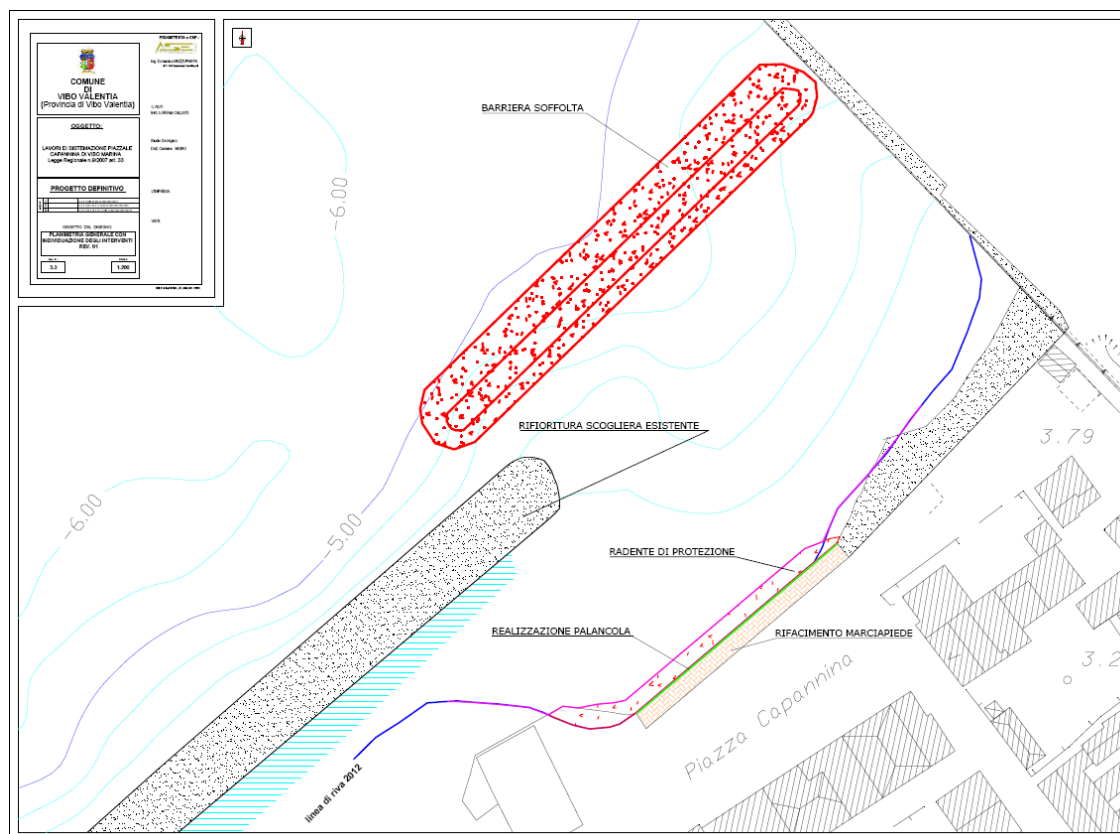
Progetto originario - Planimetria con indicazione della barriera soffolta
